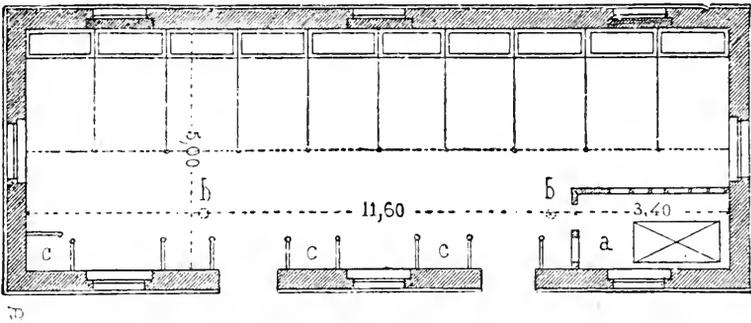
PLAN D'UNE ÉCURIE LONGITUDINALE SIMPLE.
